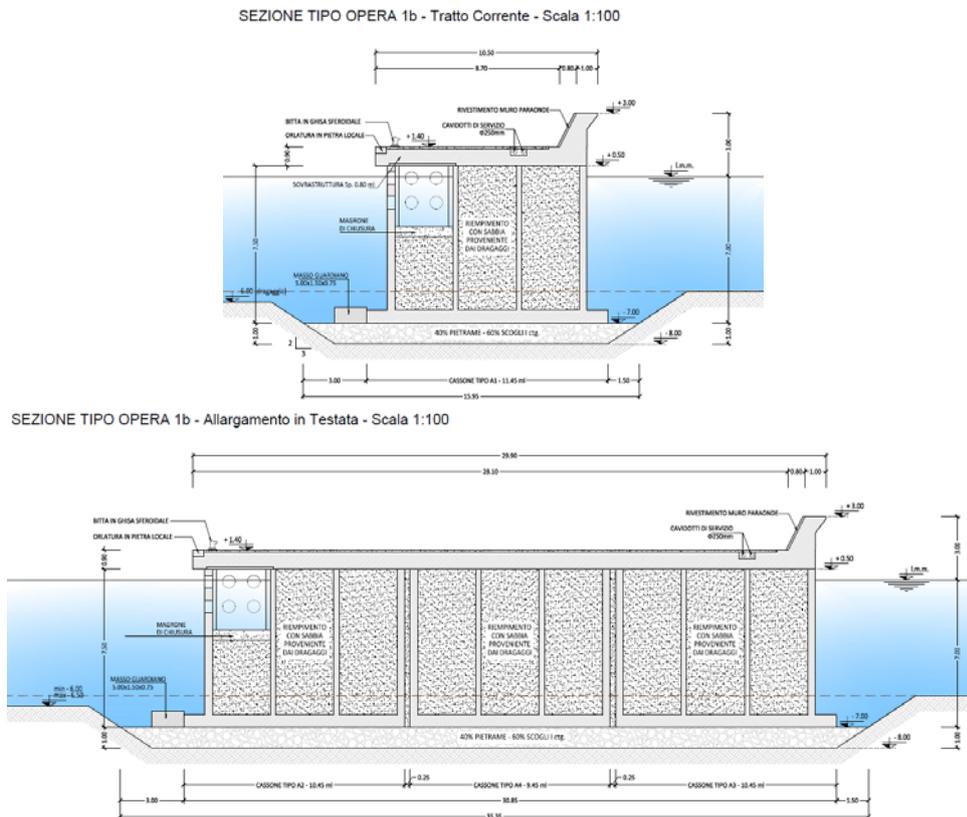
Sezioni tipo prolungamento molo di Levante – Tratto di testa (tratto corrente e di testa)
